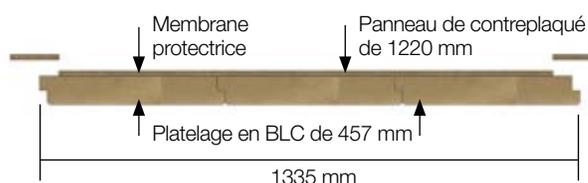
• Platelage BLC en panneaux préassemblés en usine ou au chantier
